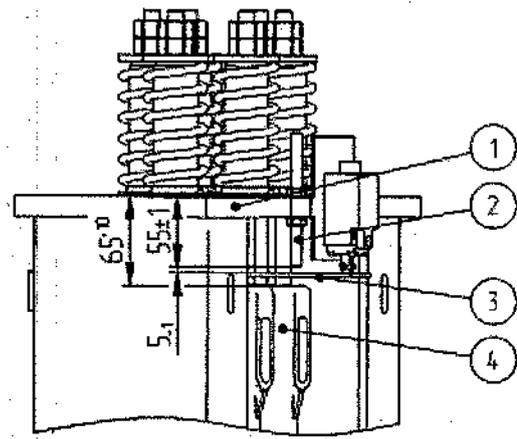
Установка подвески кабины: 1 - Опора; 2 - шпилька; 3 - планка; 4 - обойма.
